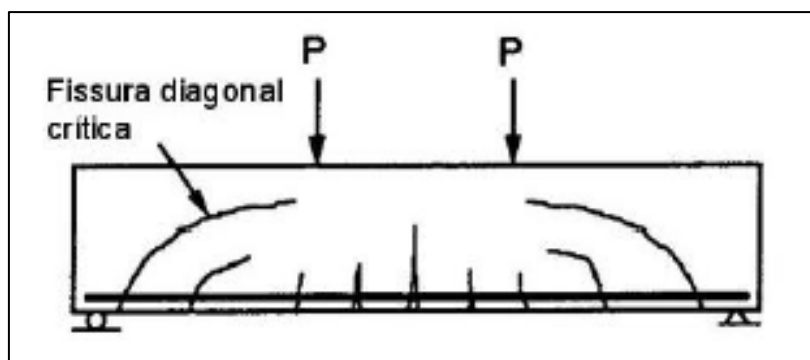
Colapso por cisalhamento de vigas armadas longitudinalmente.
